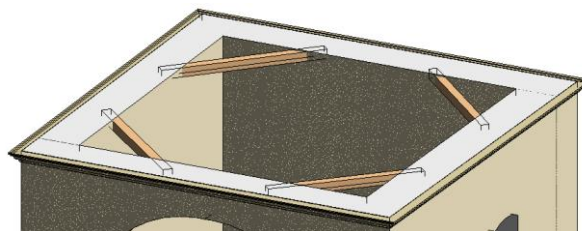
Modelado 3D las cuadrales. Fuente: elaboración propia
